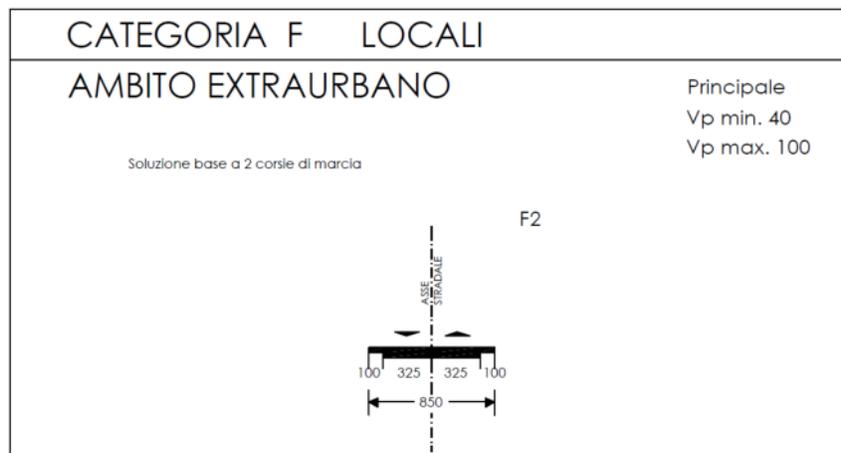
Sezione trasversale strada tipo F2 – Extraurbano
